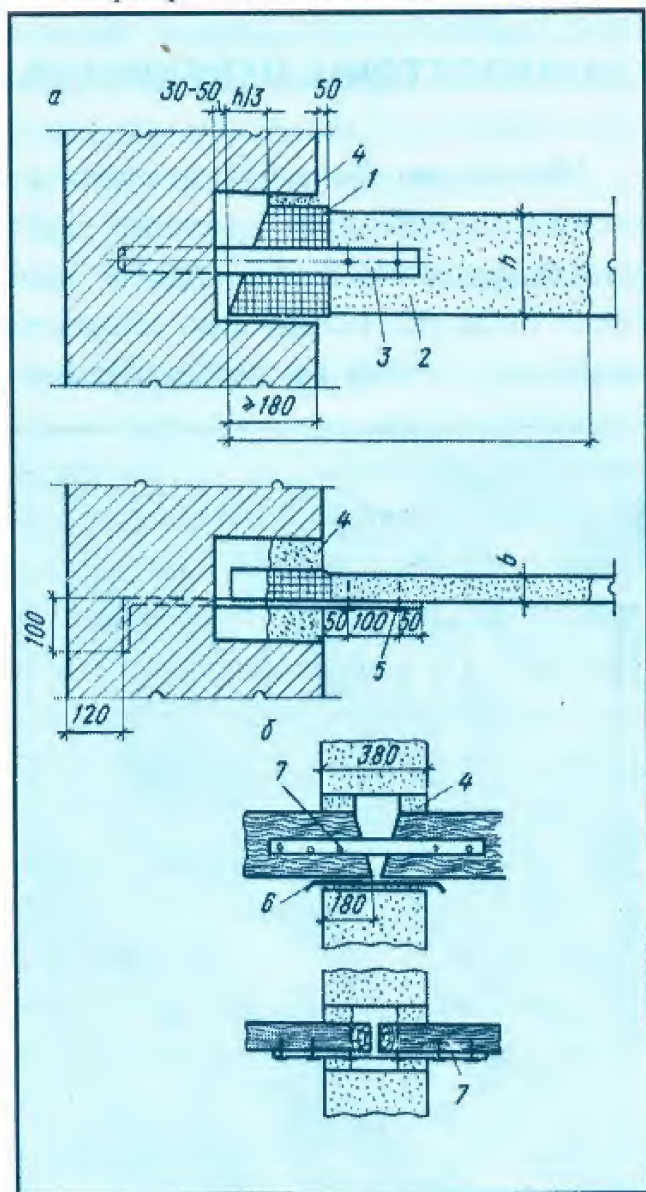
Спирання кінців дерев'яних балок на кам'яні стіни: а - зовнішні; б - внутрішні; 1 - два шари толю на смолі; 2 - антисептування; 3 - анкер 50х5 мм; 4 - цементний розчин; 5 - цвях діаметром 5 - 6 мм; 6 - два шари толю; 7 - сталевий накладний елемент 50х6 мм.
